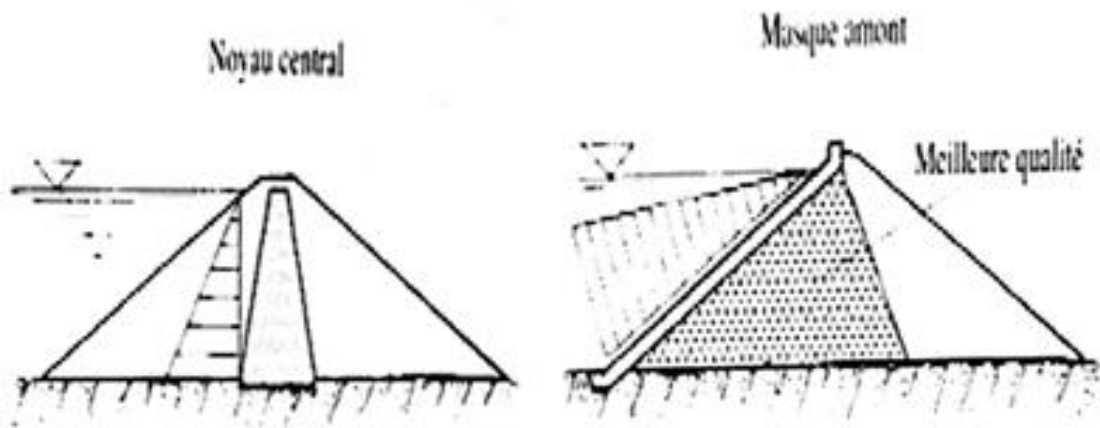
, Effet de la poussée de l'eau sur l'élément étanche d'un barrage en remblai (schleiss, 2011).
